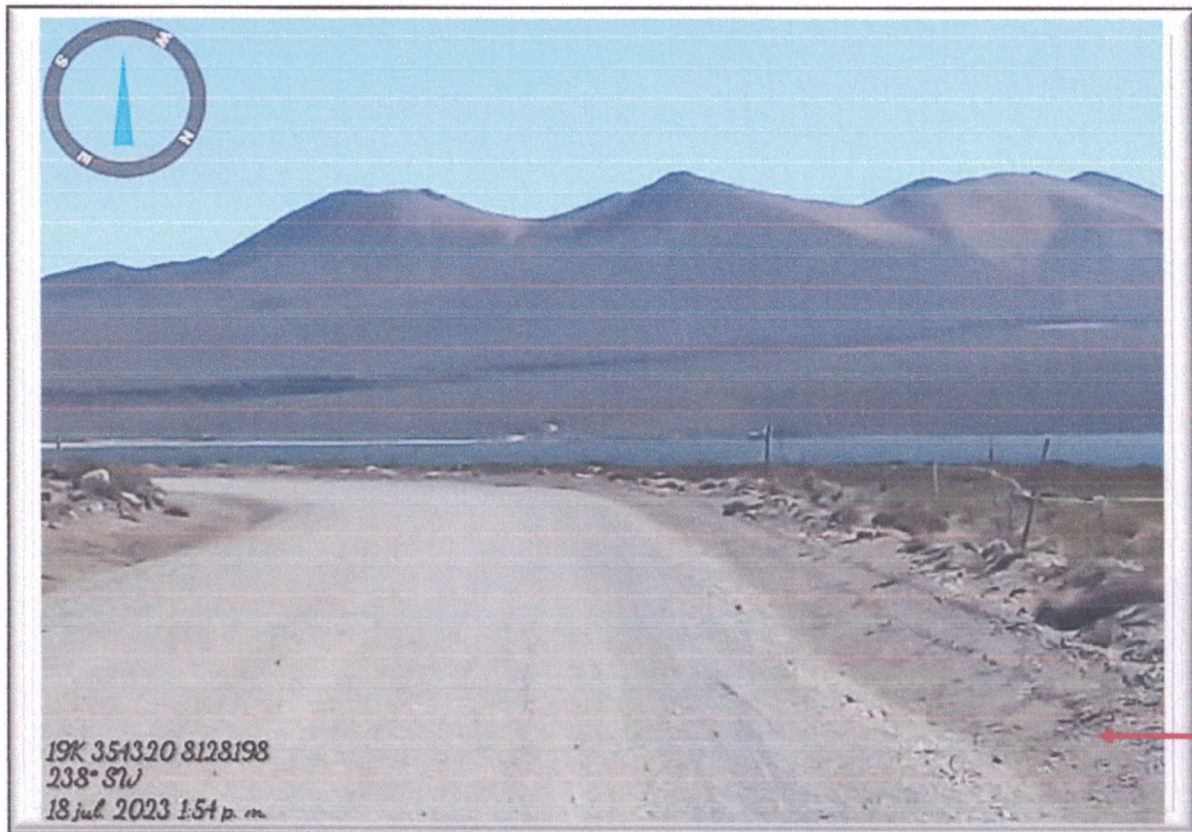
Vista de Cuneta Saturada de Arena y piedras.
